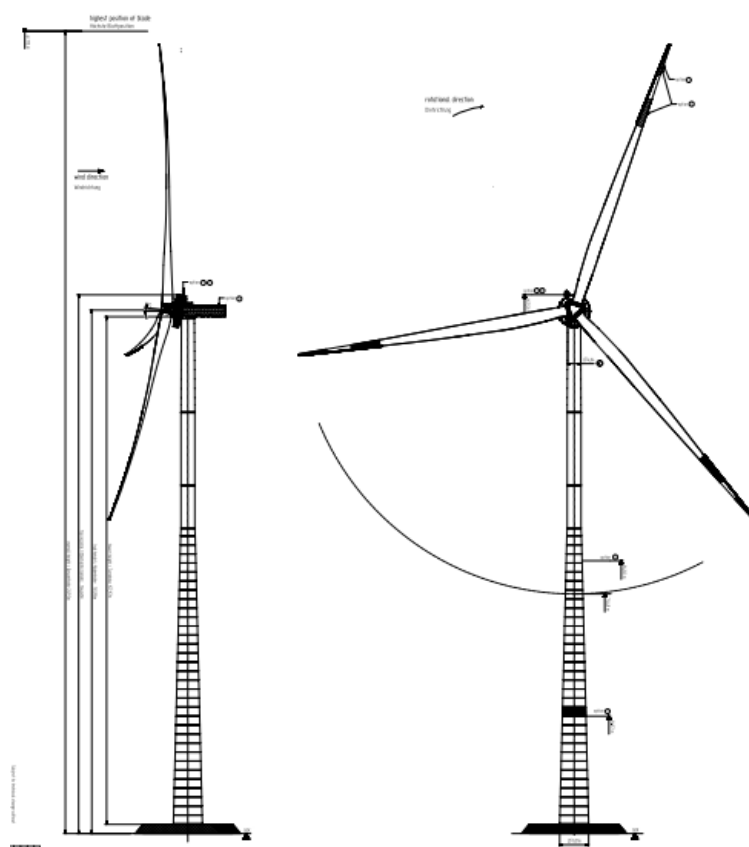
D02885451_2.0__Layout drawing_precast concrete tower Enercon
